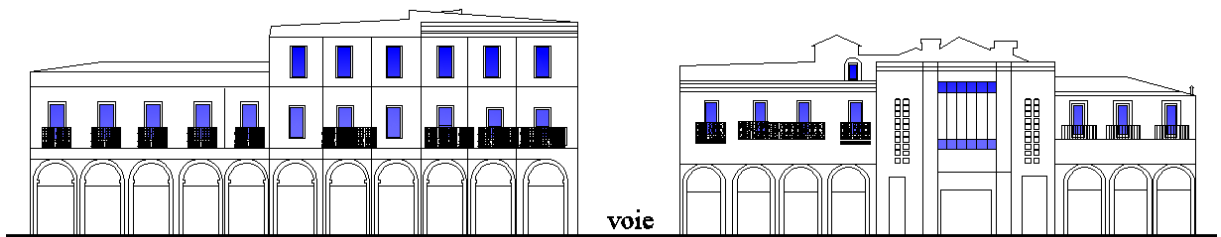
Façade Sud-ouest (place du 1er Novembre) dessiné sur Autodesk-Autocad.
